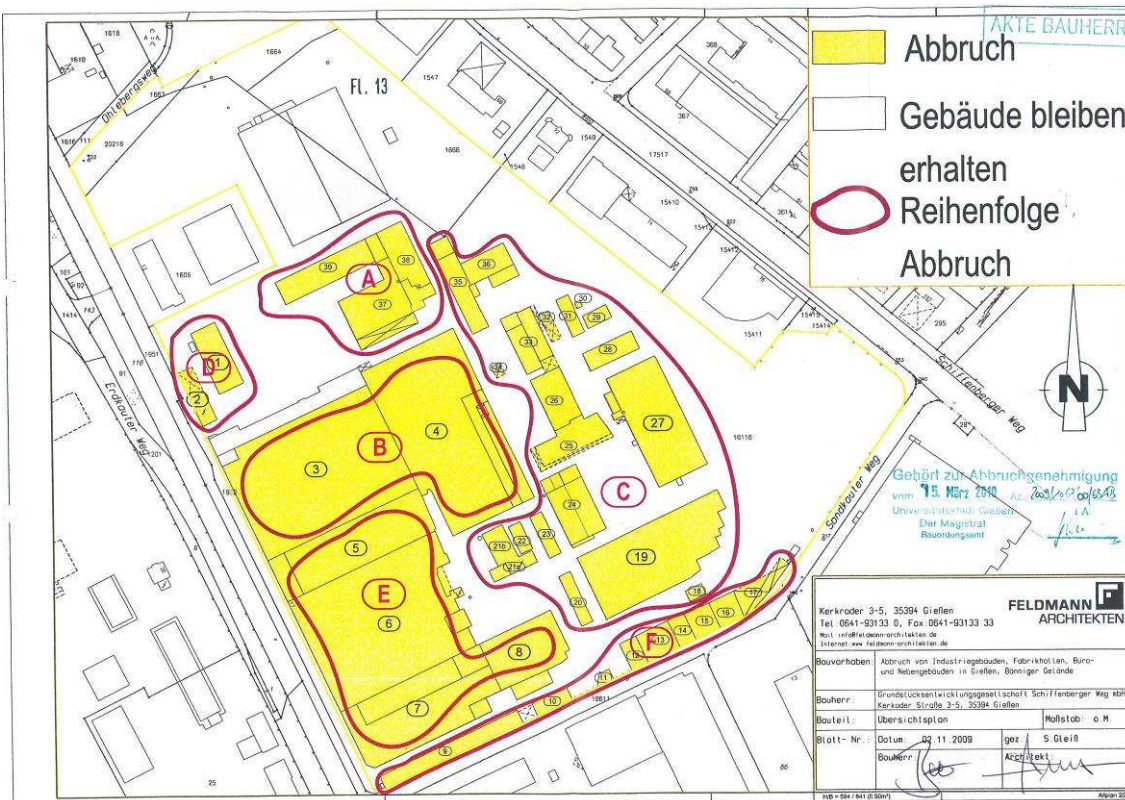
Übersichtsplan mit Reihenfolge des Abbruchs aus dem Abbruchgesuch, 02.11.2009, ohne Maßstab
